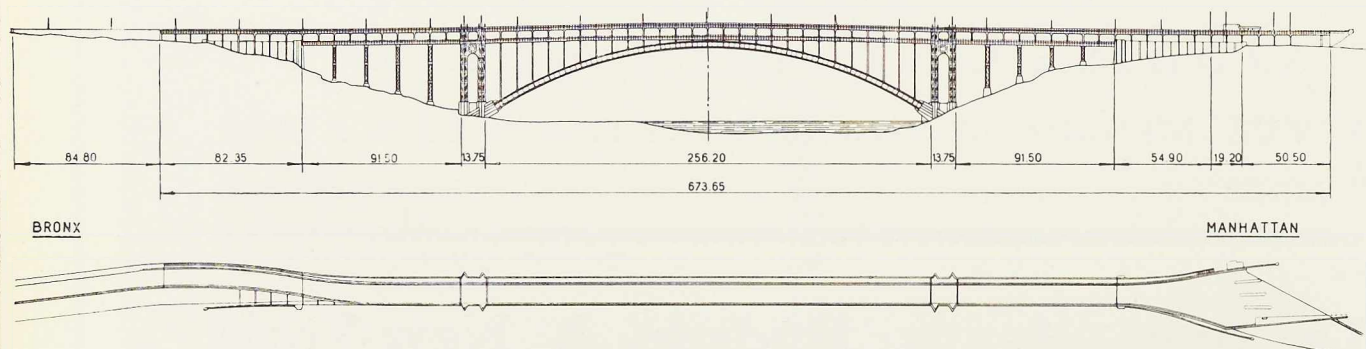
Elevation et vue en plan de l'ouvrage définitif.
